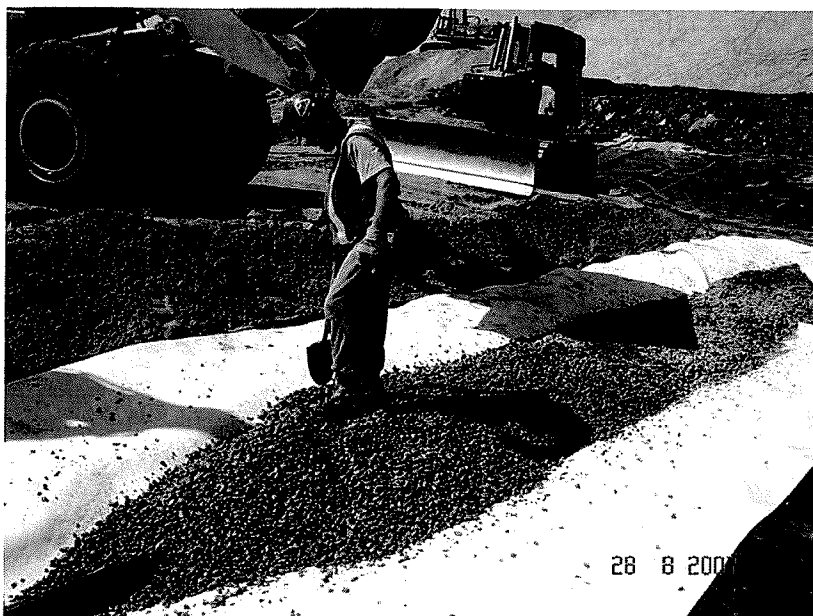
Mise en place du massif de drainage (sable) et de la pierre nette au niveau du système de drainage
